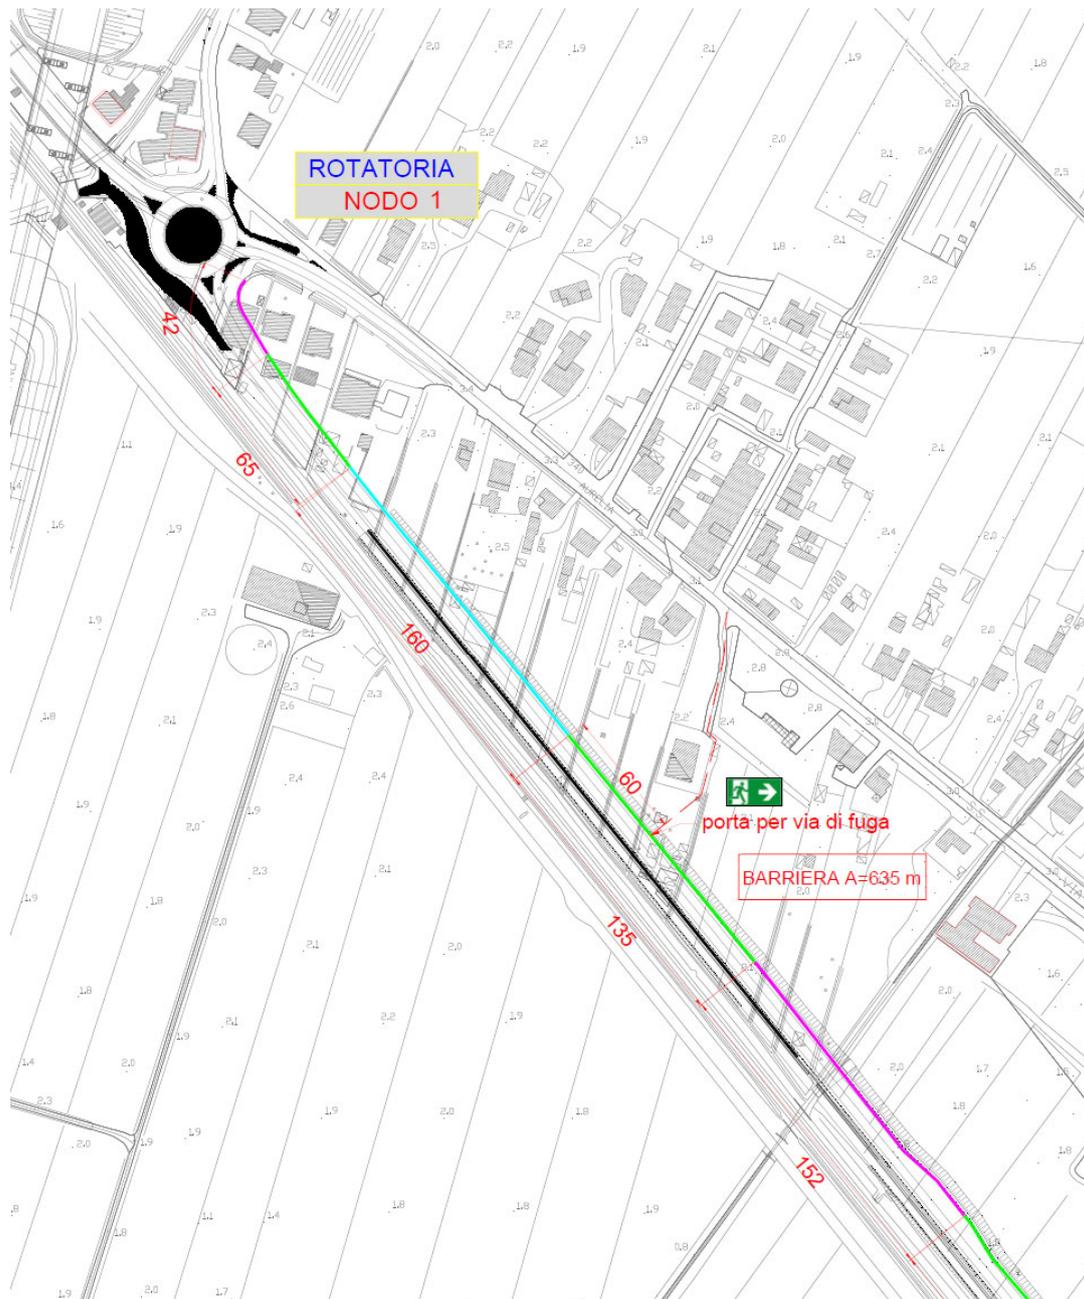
Planimetria barriere acustiche tratto 1-2 (lotto 1-2 stralcio)
